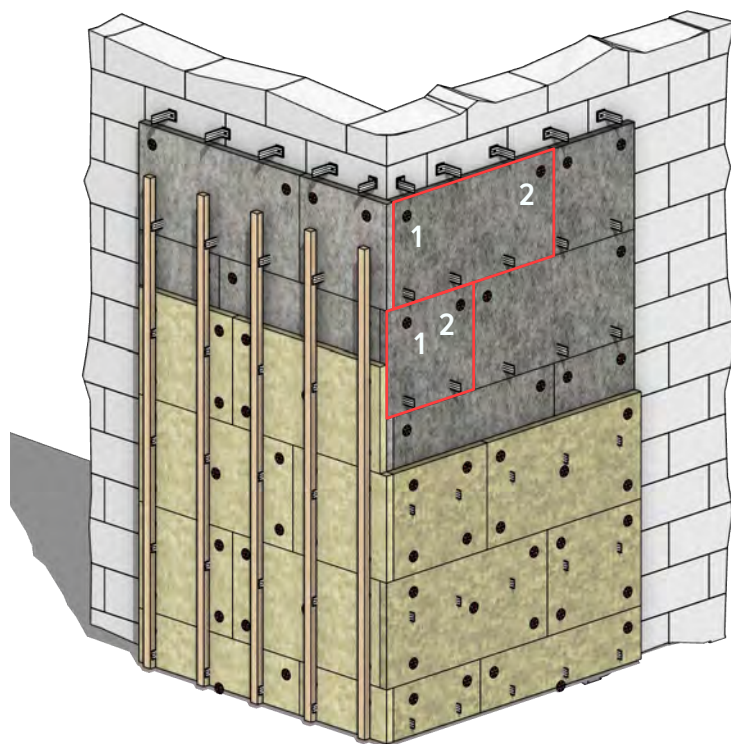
Системы навесного фасада с установленным утеплителем.
